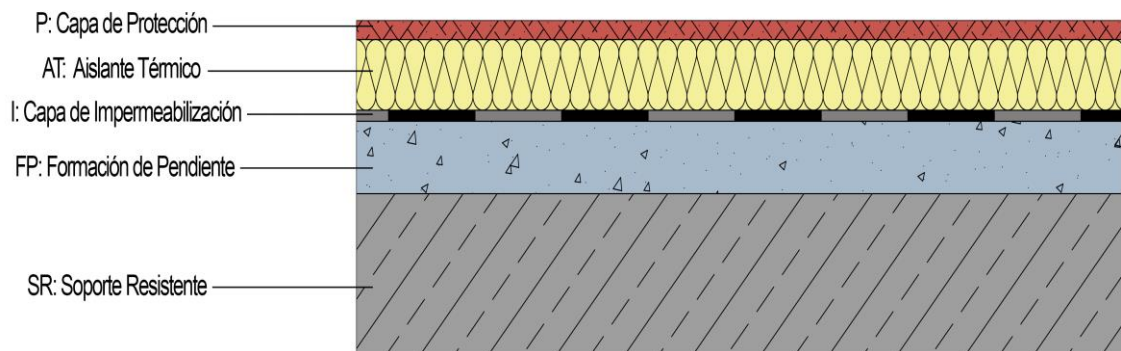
Representación de la cubierta plana invertida sin cámara de aire I.
